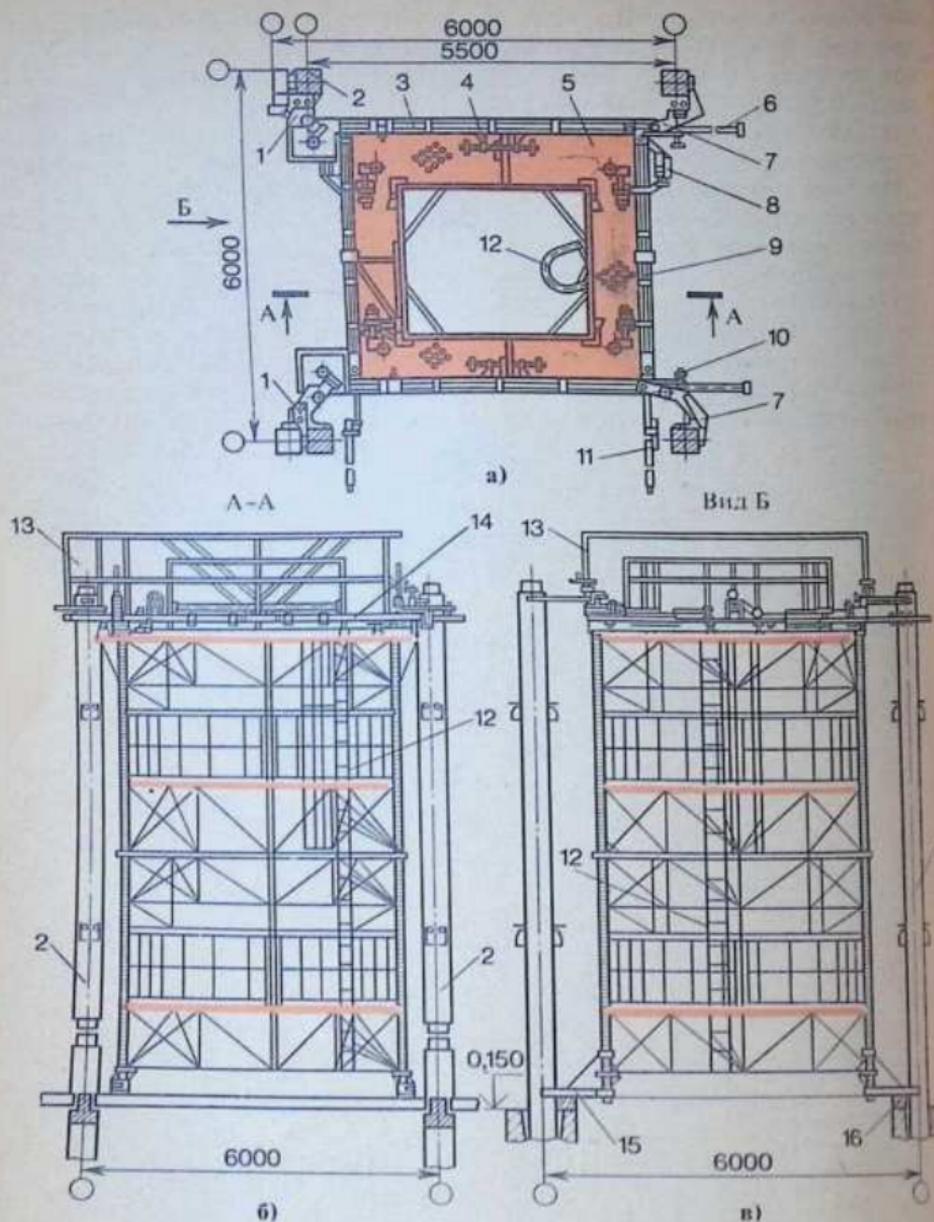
Рамно-шарнирный индикатор (РШИ):
